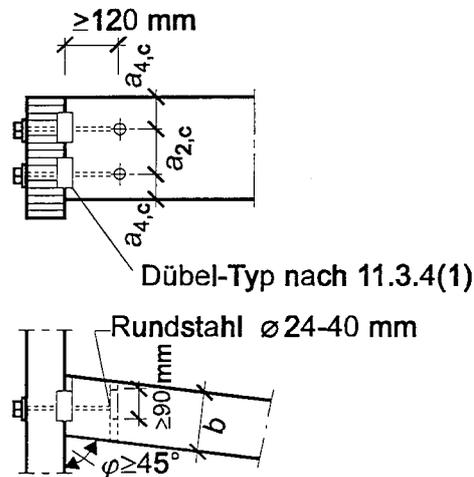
Ausbildung eines Hirnholzanschlusses mit Dübeln besonderer Bauart
